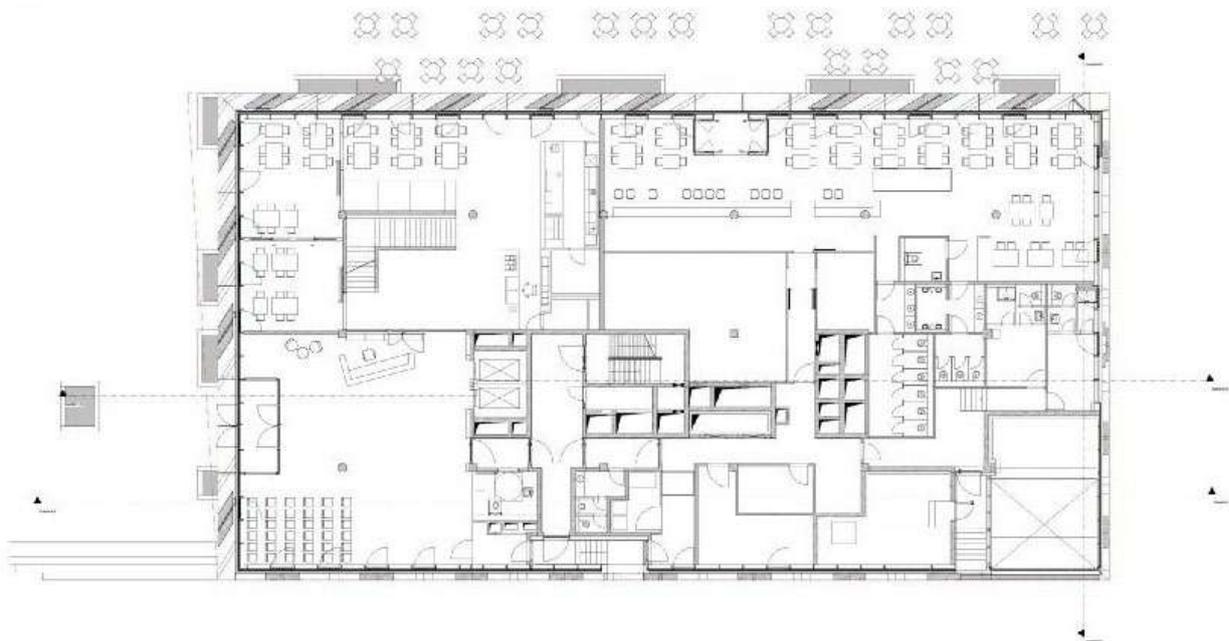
Grundriss EG *The Cradle*¹²⁵
